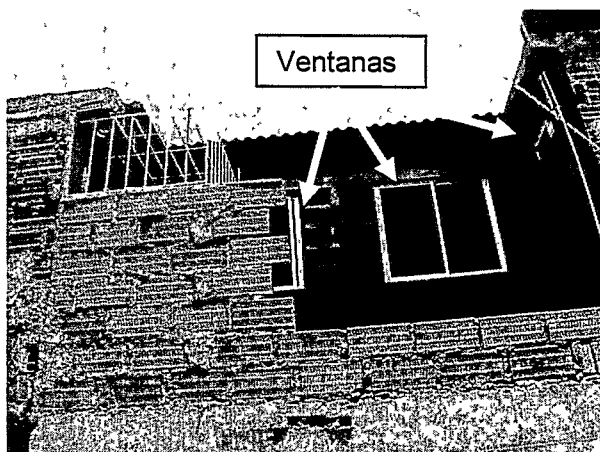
Fachada posterior del inmueble Barrio La Consolata MzB L6, donde se observan la ubicación de ventanas.
